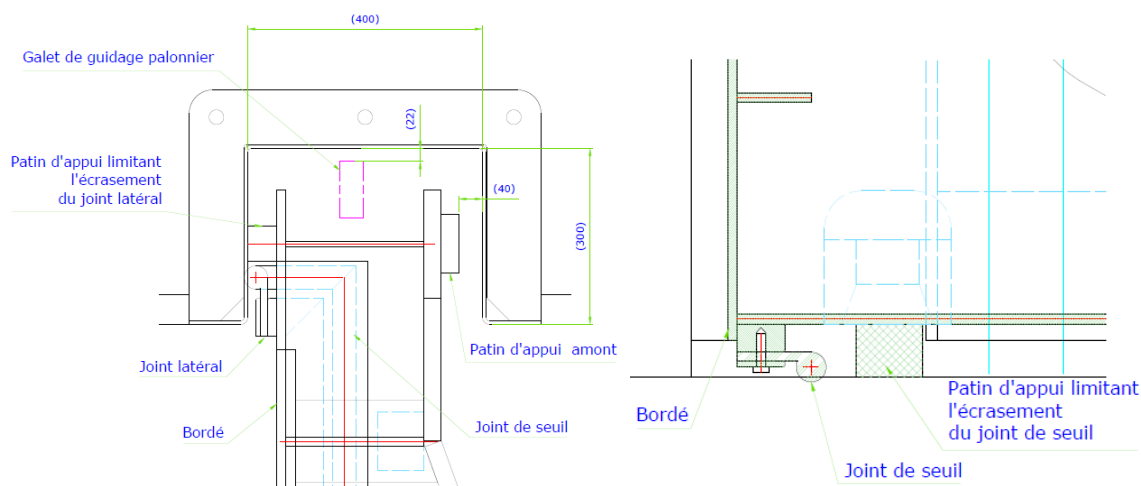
Guidage (vue dessus) et étanchéité de seuil (coupe)
